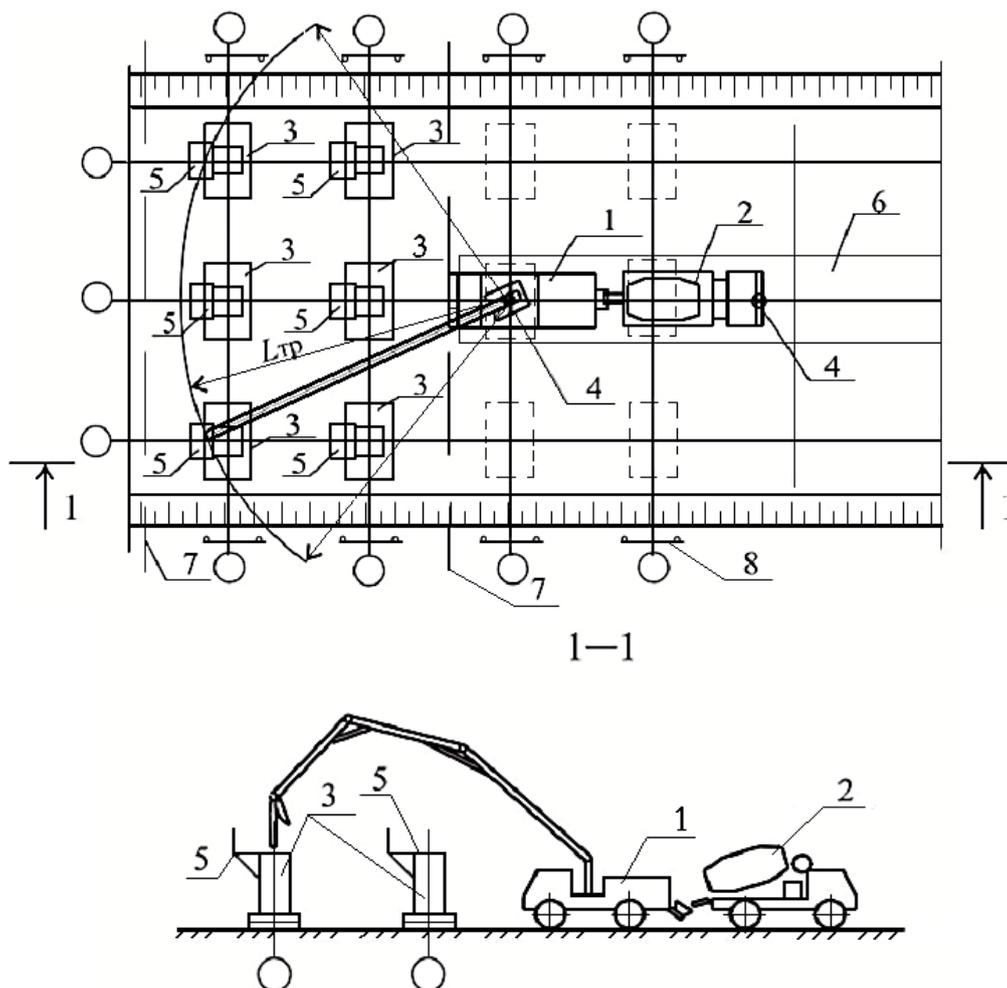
Технологическая схема бетонирования фундаментов при помощи автобетононасоса:
